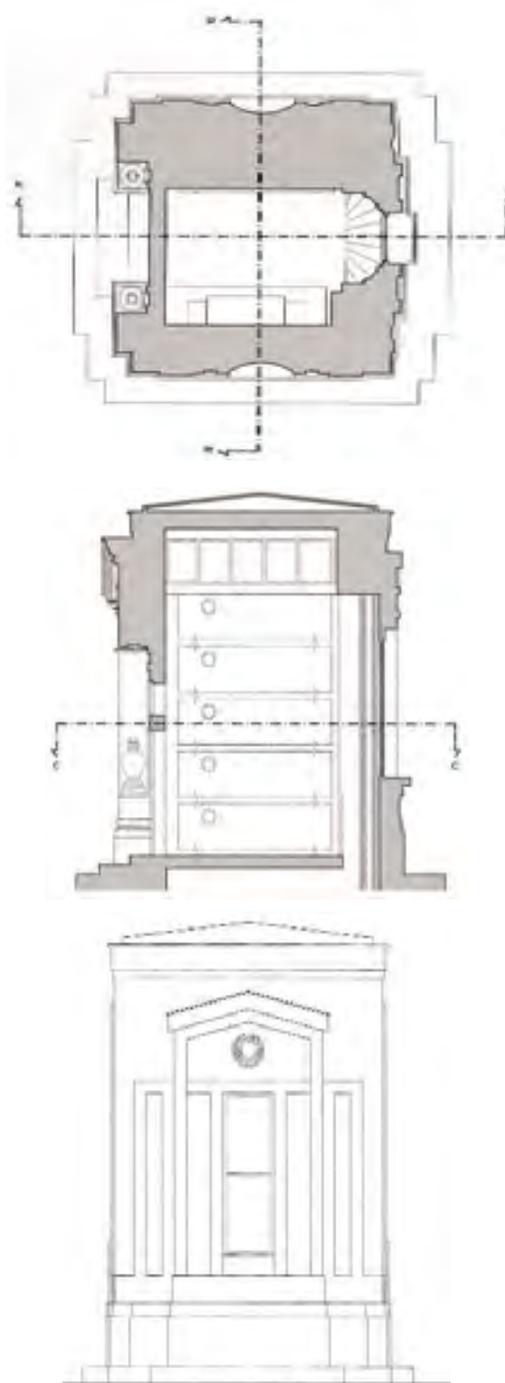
Rilievo geometrico di un'edicola funeraria: pianta, sezione e prospetto.
